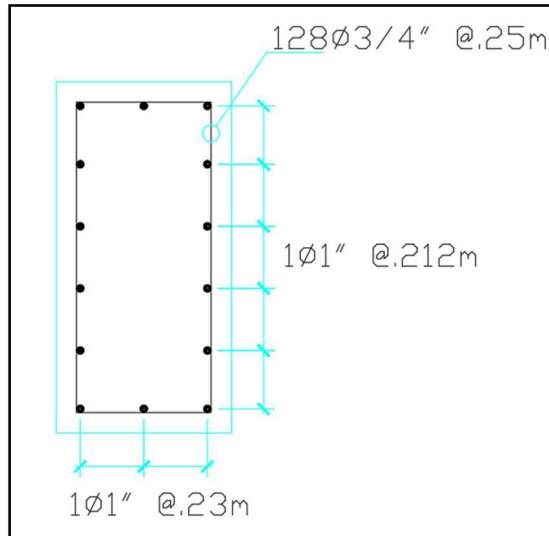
Distribución acero refuerzo viga 1.20 m x 0.60 m.
